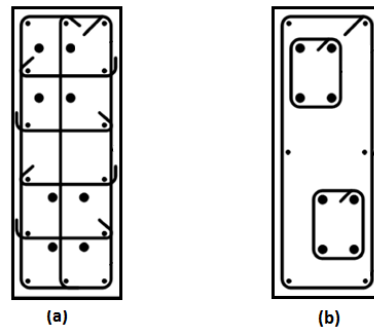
Armadura de Refuerzo Transversal en vigas de acople. (a) ACI 318H-CH047. (b) ACI 318-05.
